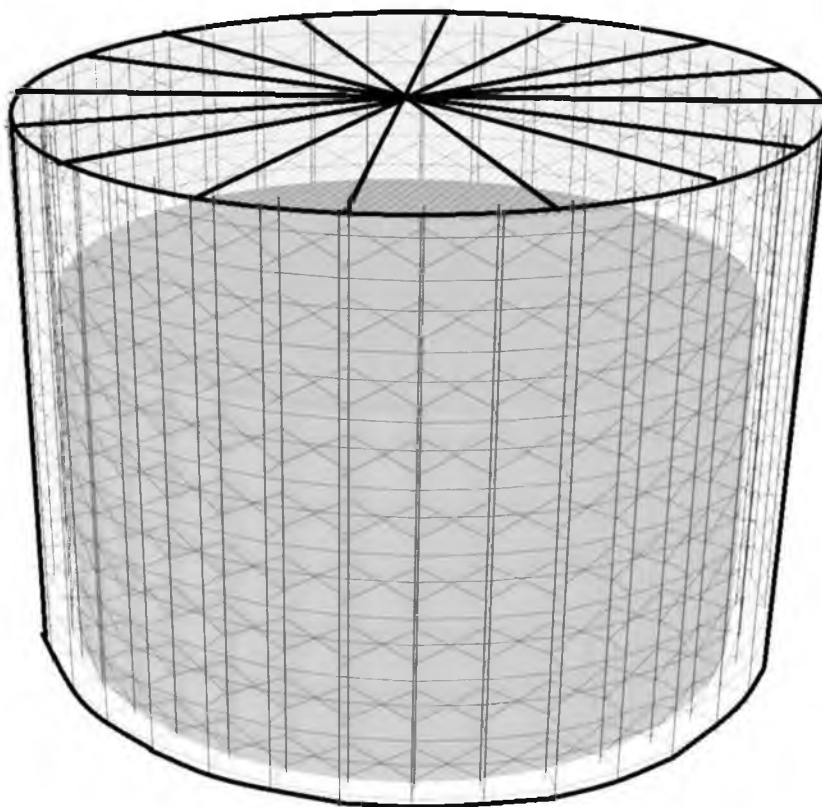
Схема укрытия вертикального резервуара с использованием строительных лесов и сетки рабица
